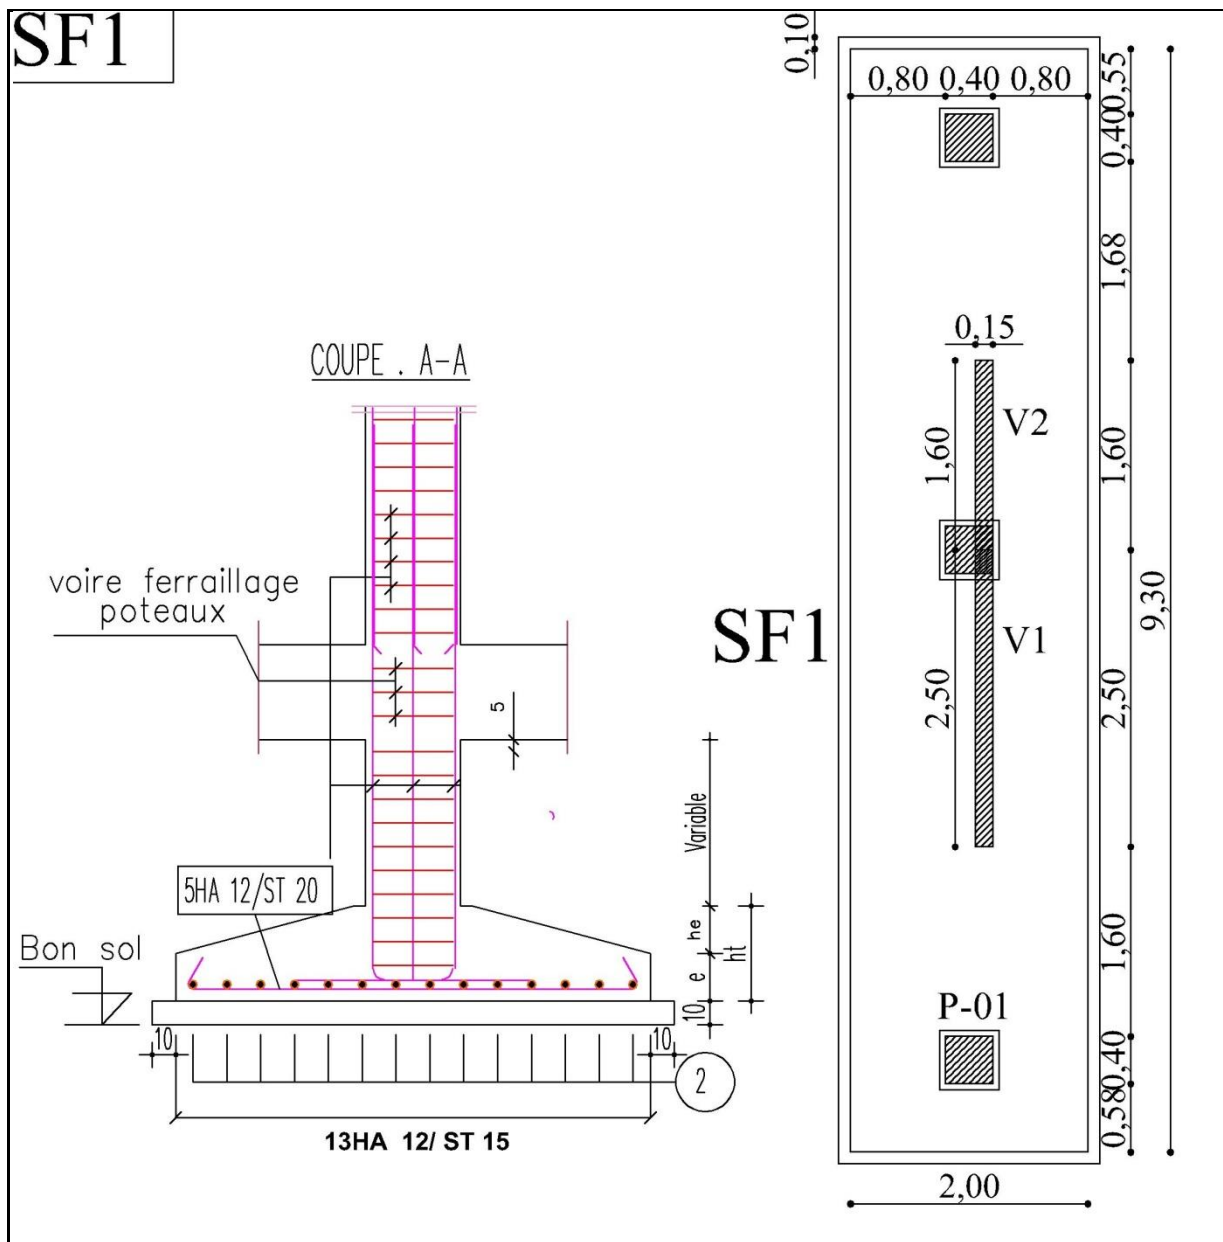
Schéma exemplaire de ferrailage de la semelle filante SF1
